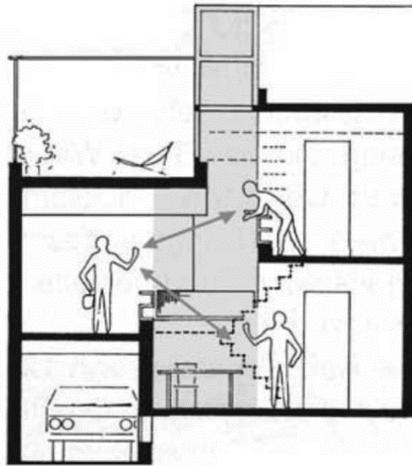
Alzado de Diagoon House, fachada. Delf, Holanda.
